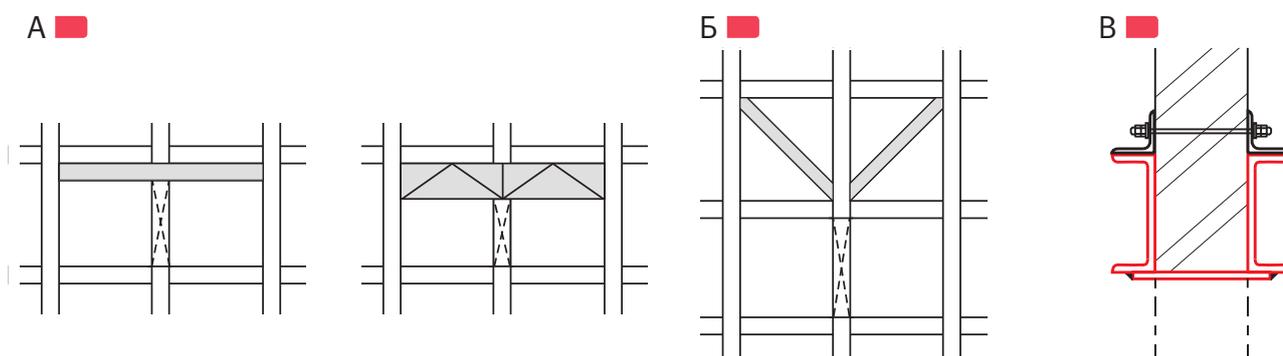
Замена существующих колонн: А – на балки или фермы; Б – на аутригеры высотой в этаж; штрих – изымаемая часть колонны; закрашенные области – новые элементы; В – пример узла перехвата балками легкого кирпичного простенка
